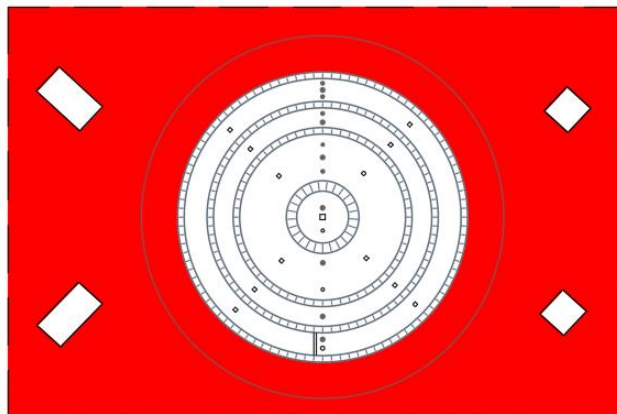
Planta: Área de rojo que muestra el sector del piso alrededor de la pileta donde se colocará un manto asfáltico gravillado para impermeabilizar el sector.
